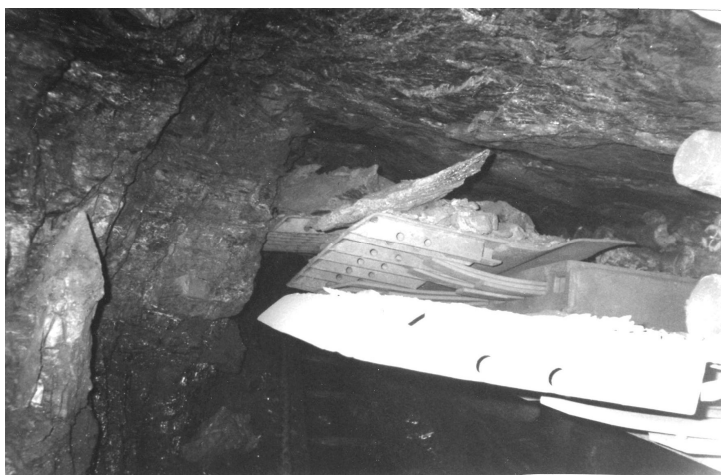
Фотофрагмент вывалообразований кровли под забоем
